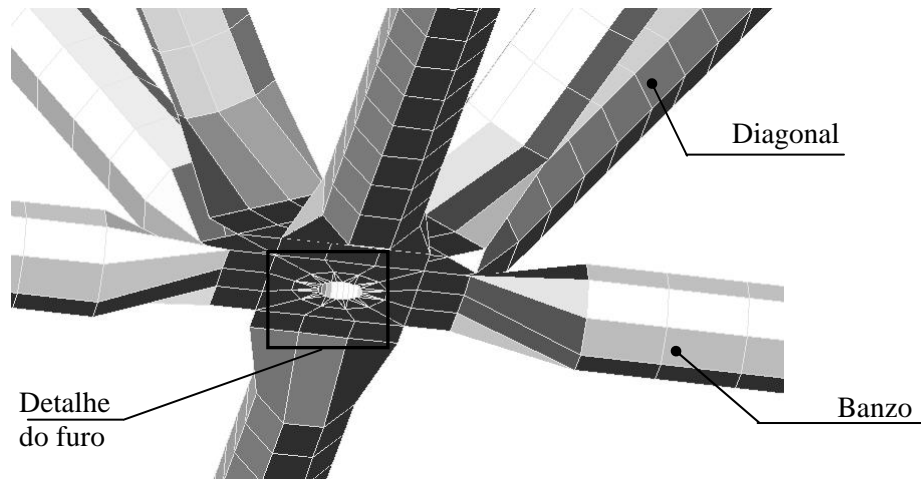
Detalhe da malha do nó 9 central de aplicação do carregamento
